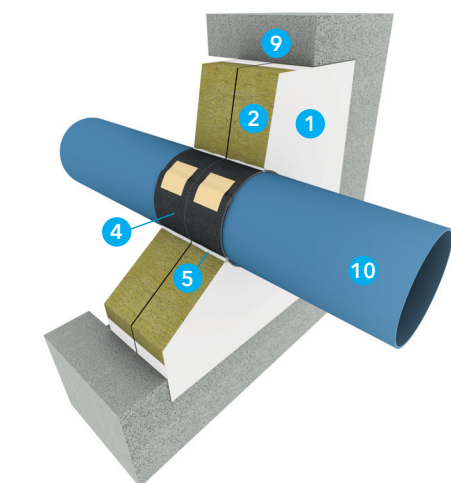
#### Detail U - průstup plastového potrubí ve stropěch<sup>2)</sup> - zapuštěná montáž
